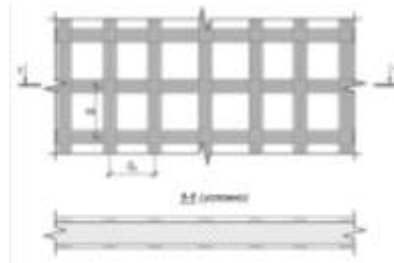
Усиление каменной кладки за счет системы внешнего армирования углеволокном
